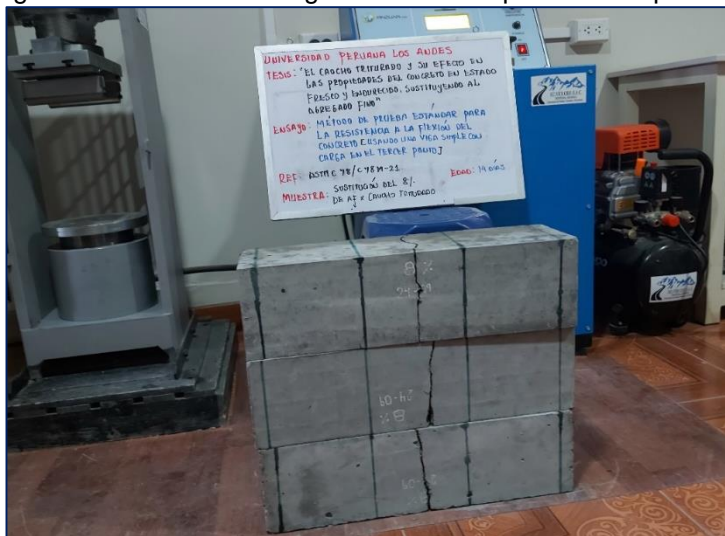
Vista de las fallas en las viguetas de concreto con adición de caucho.
